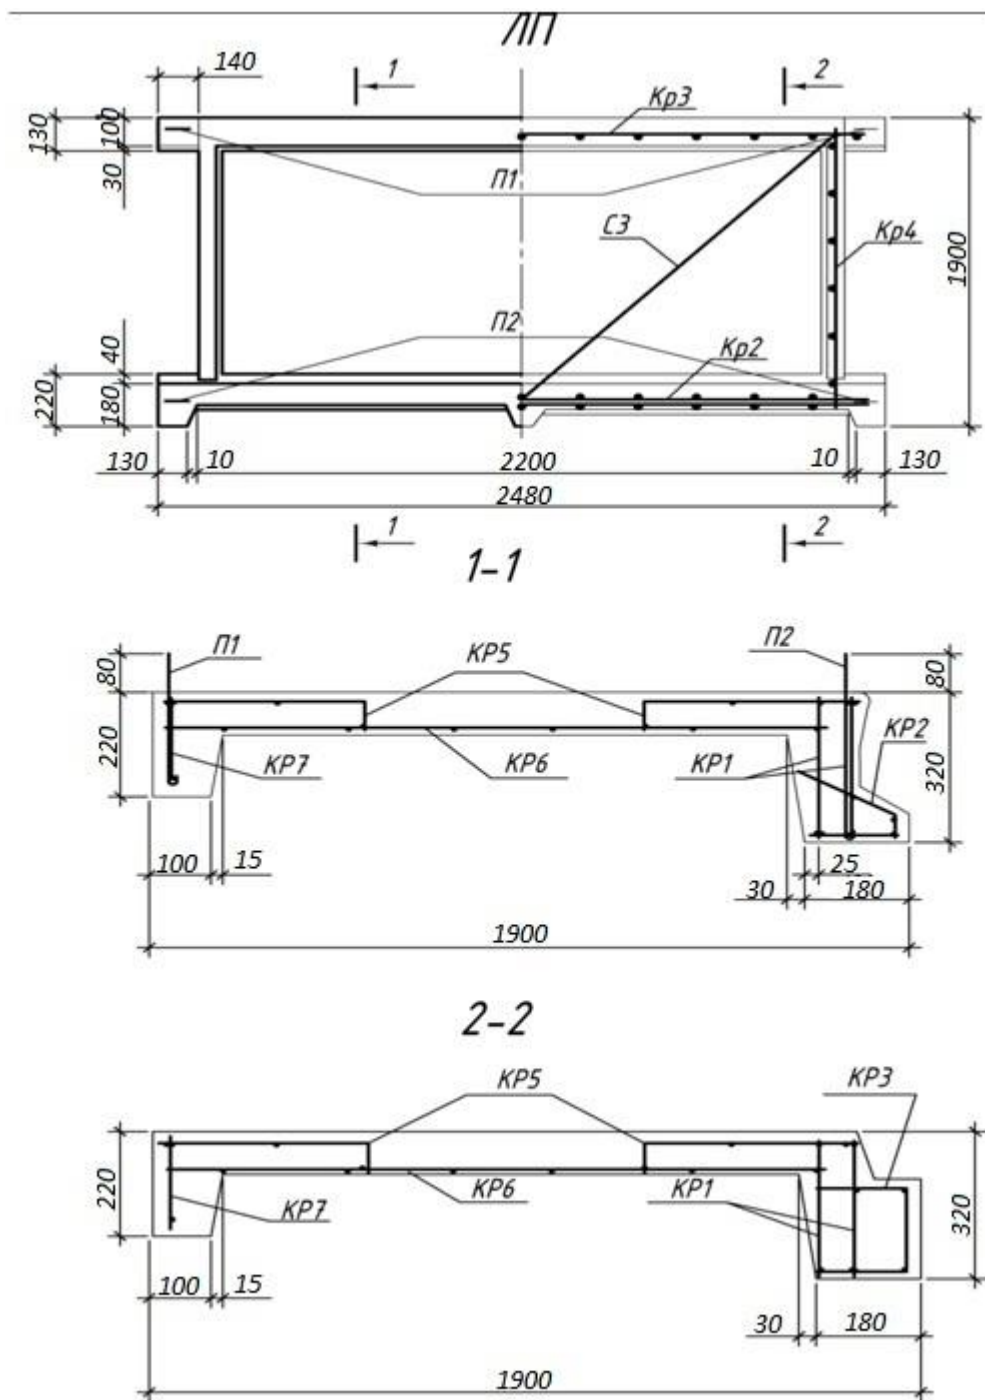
К расчёту плиты лестничной площадки. Общий вид и детали армирования.
